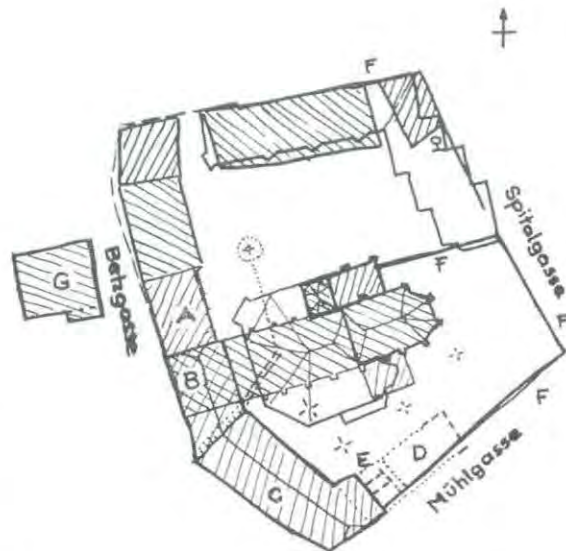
Grundriss des Spitalkomplexes um 1965
